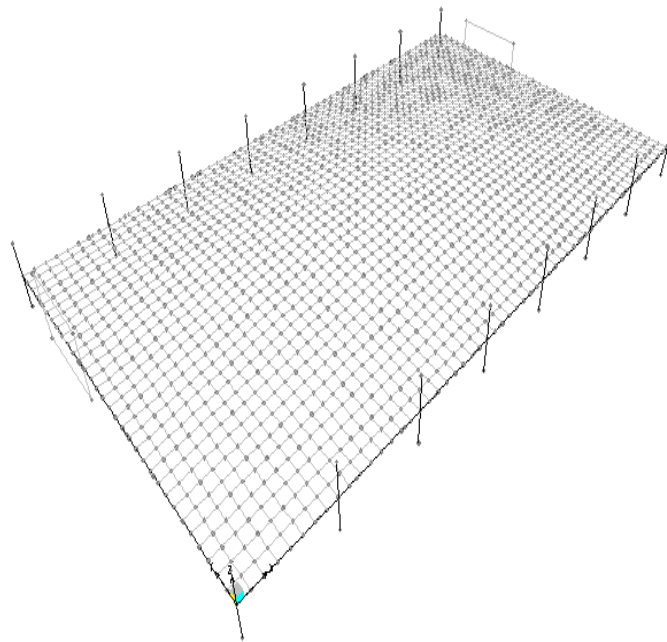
Modelo estrutural adoptado para o piso do edifício em análise, Sap2000
